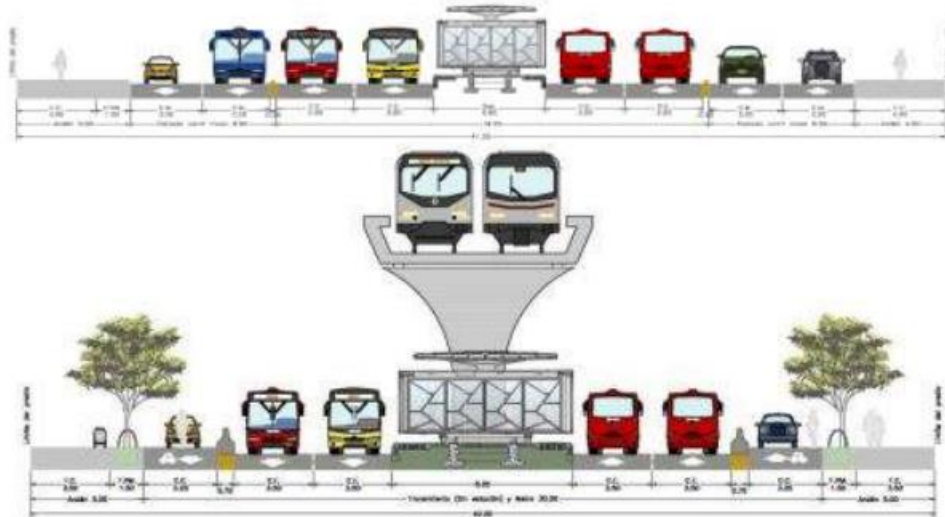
Sección transversal a nivel de estación en la Av. Caracas entre la Calle 26 y la Calle 72.
